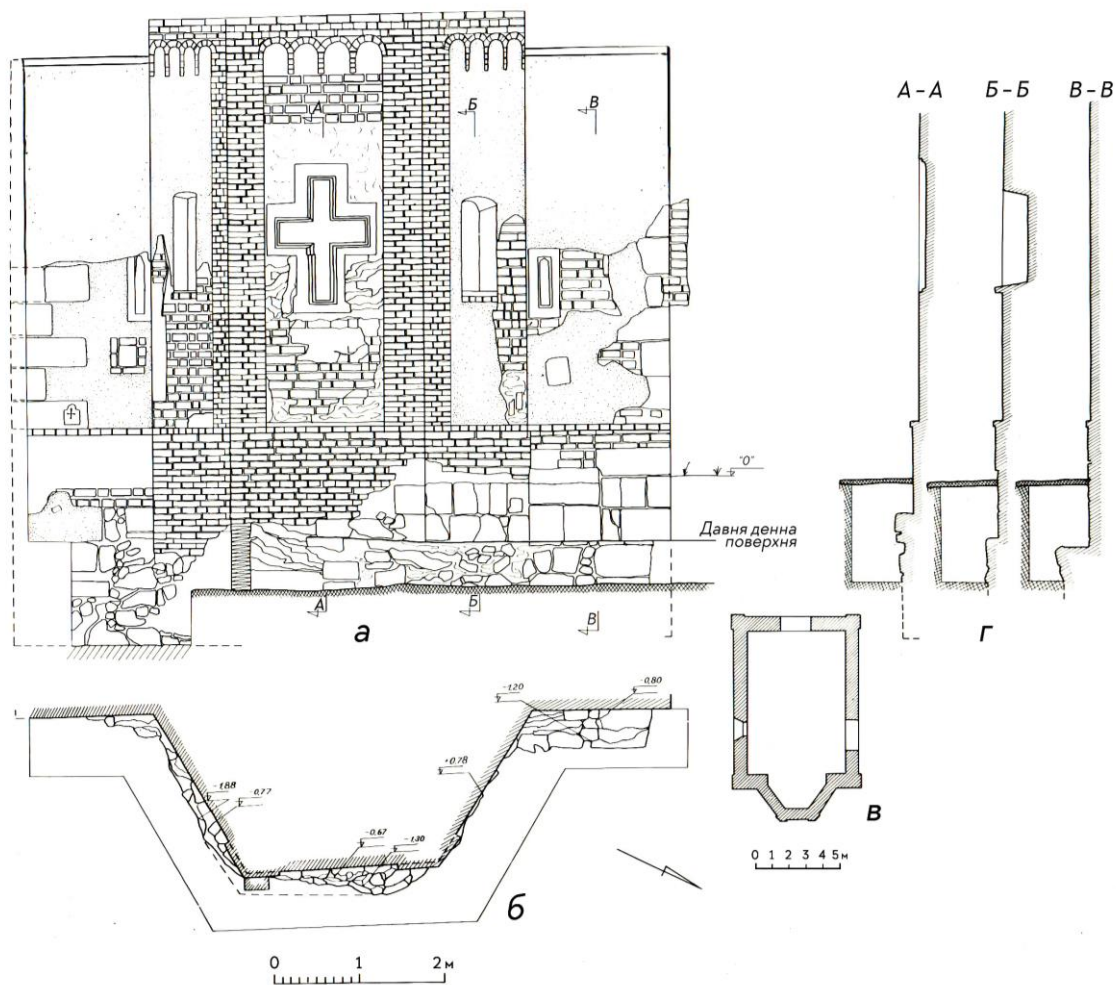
Костел Івана Хрестителя. Археологічні дослідження 1977 р.: а – креслення східного фасаду; б – план розкопу; в – схематичний план костелу без добудов; г – профілі (Малевская, 1978, рис. 16).
